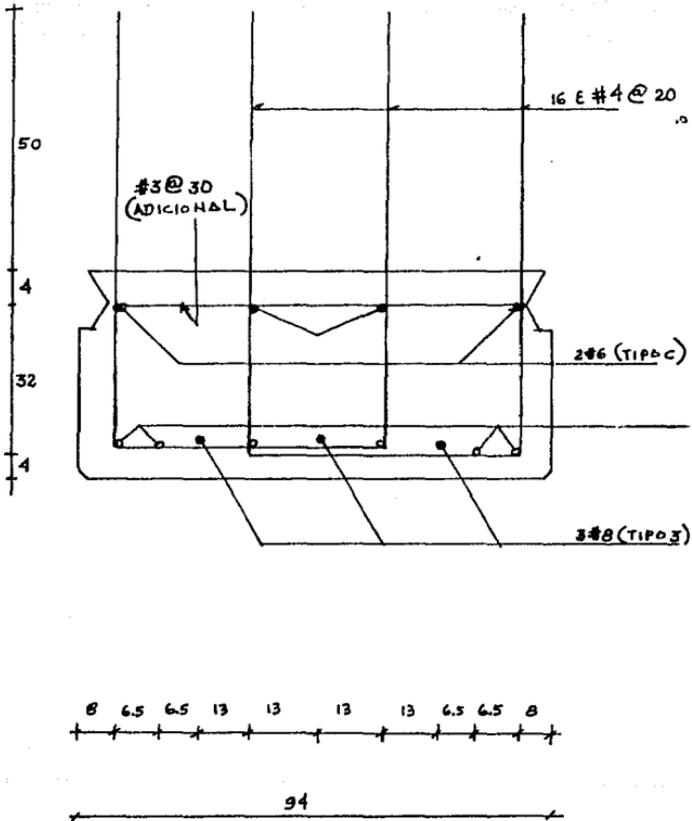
ELEMENTO PREFABRICADO O TABLETA PRECOLADA.
